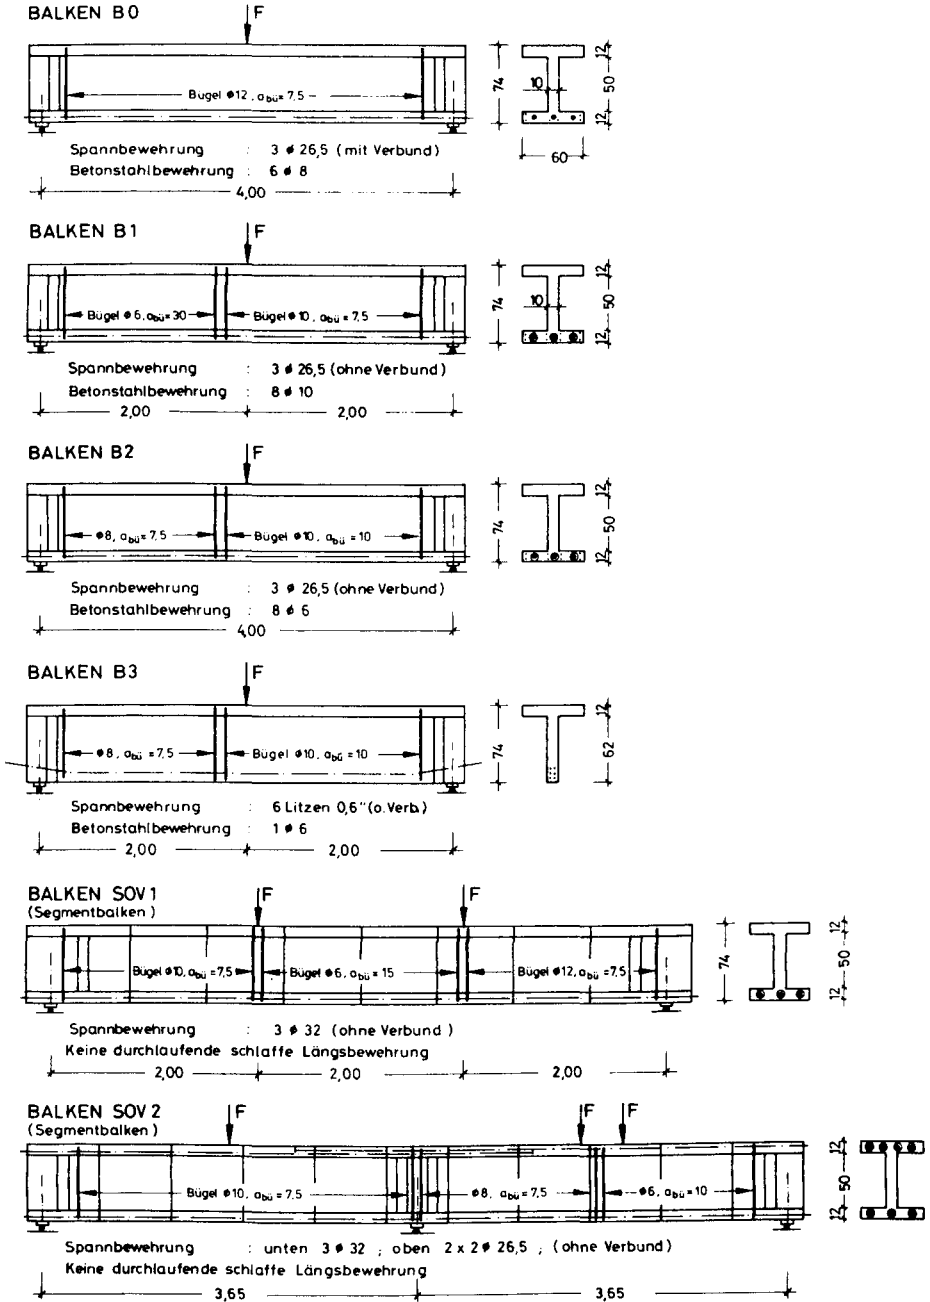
Abmessungen und Bewehrung der Versuchs balken
